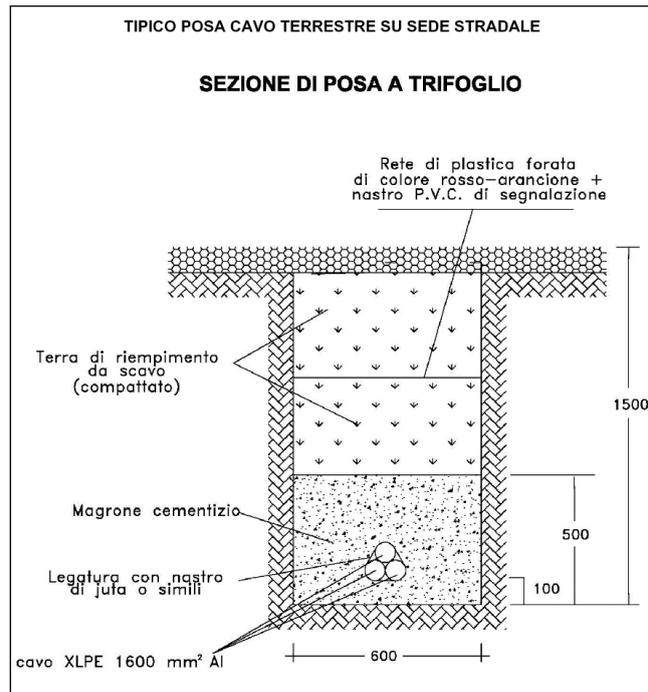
Tipico posa cavo terrestre su sede stradale
